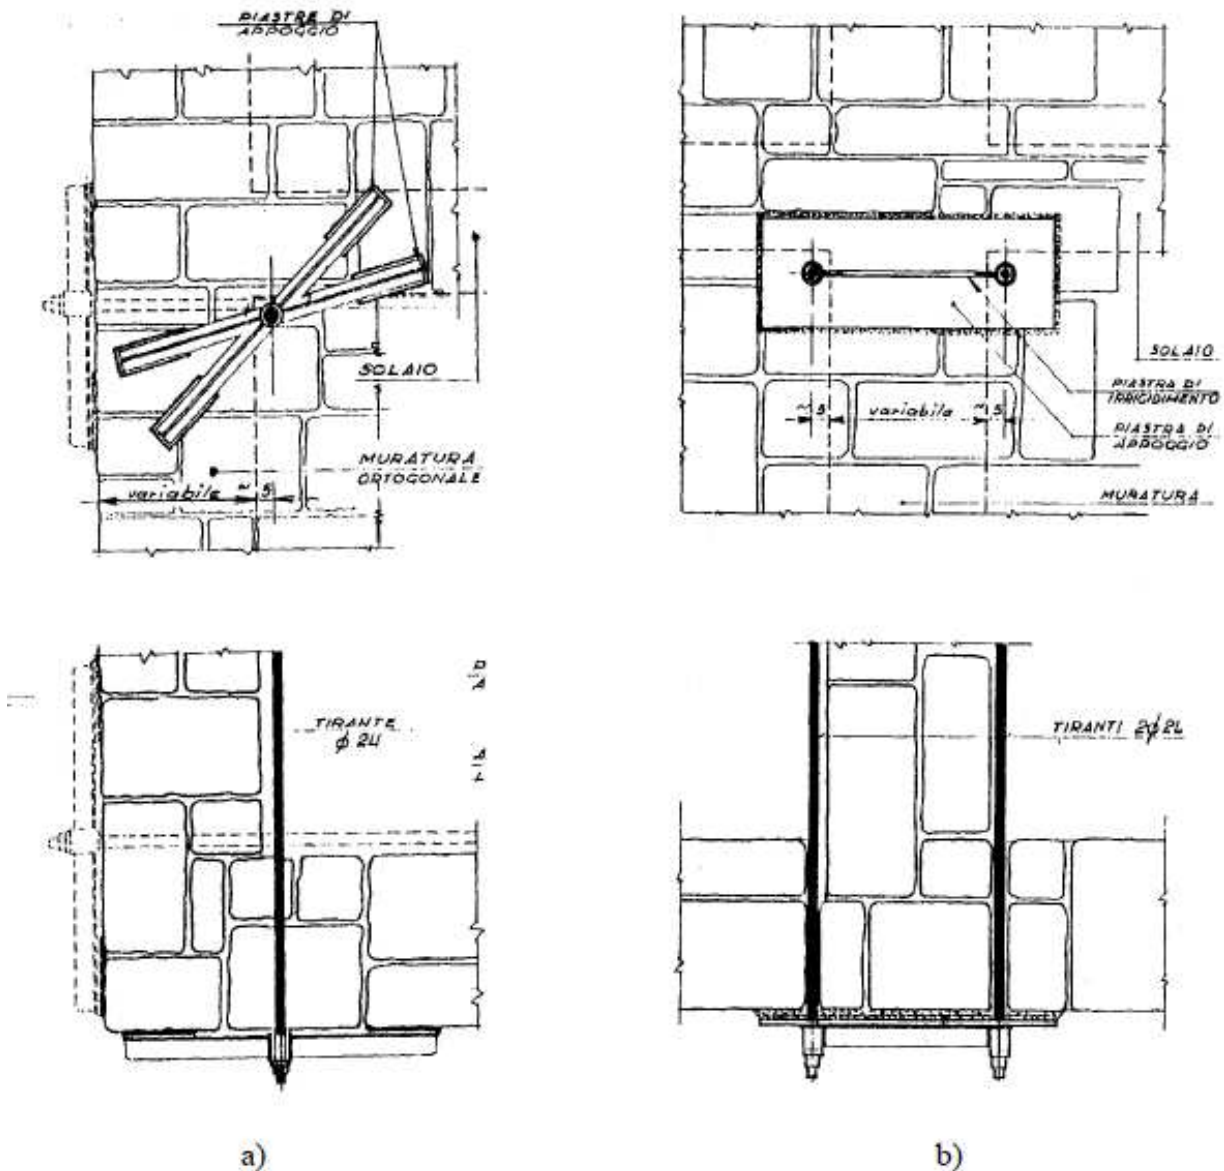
Sistema di ancoraggio: con chiavi in acciaio (a)
